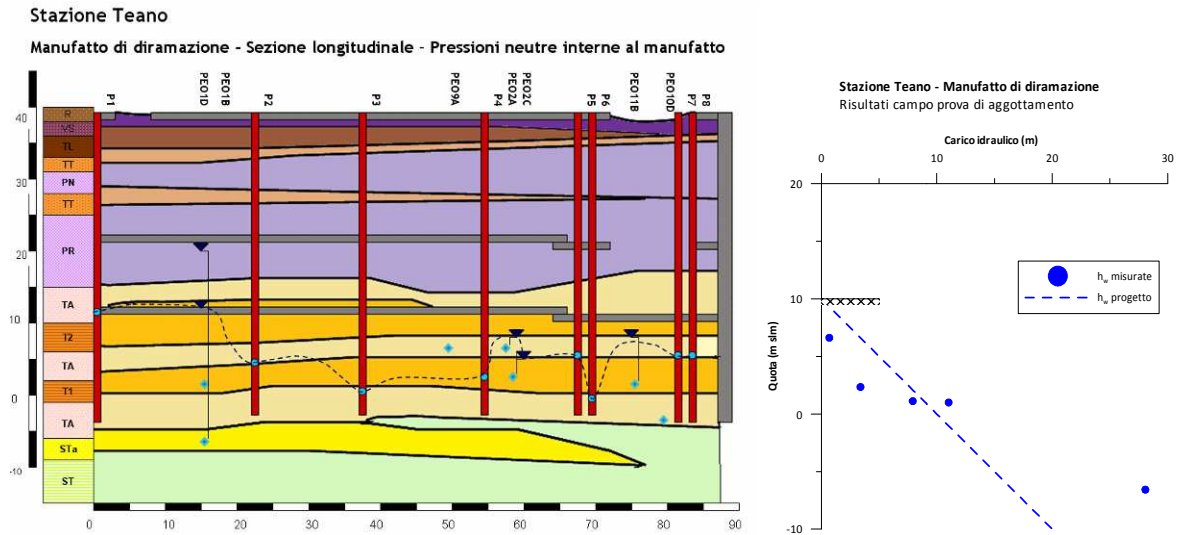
Stazione Teano: manufatto di diramazione: profilo delle pressioni neutre al di sotto del fondo scavo – Sezione longitudinale
